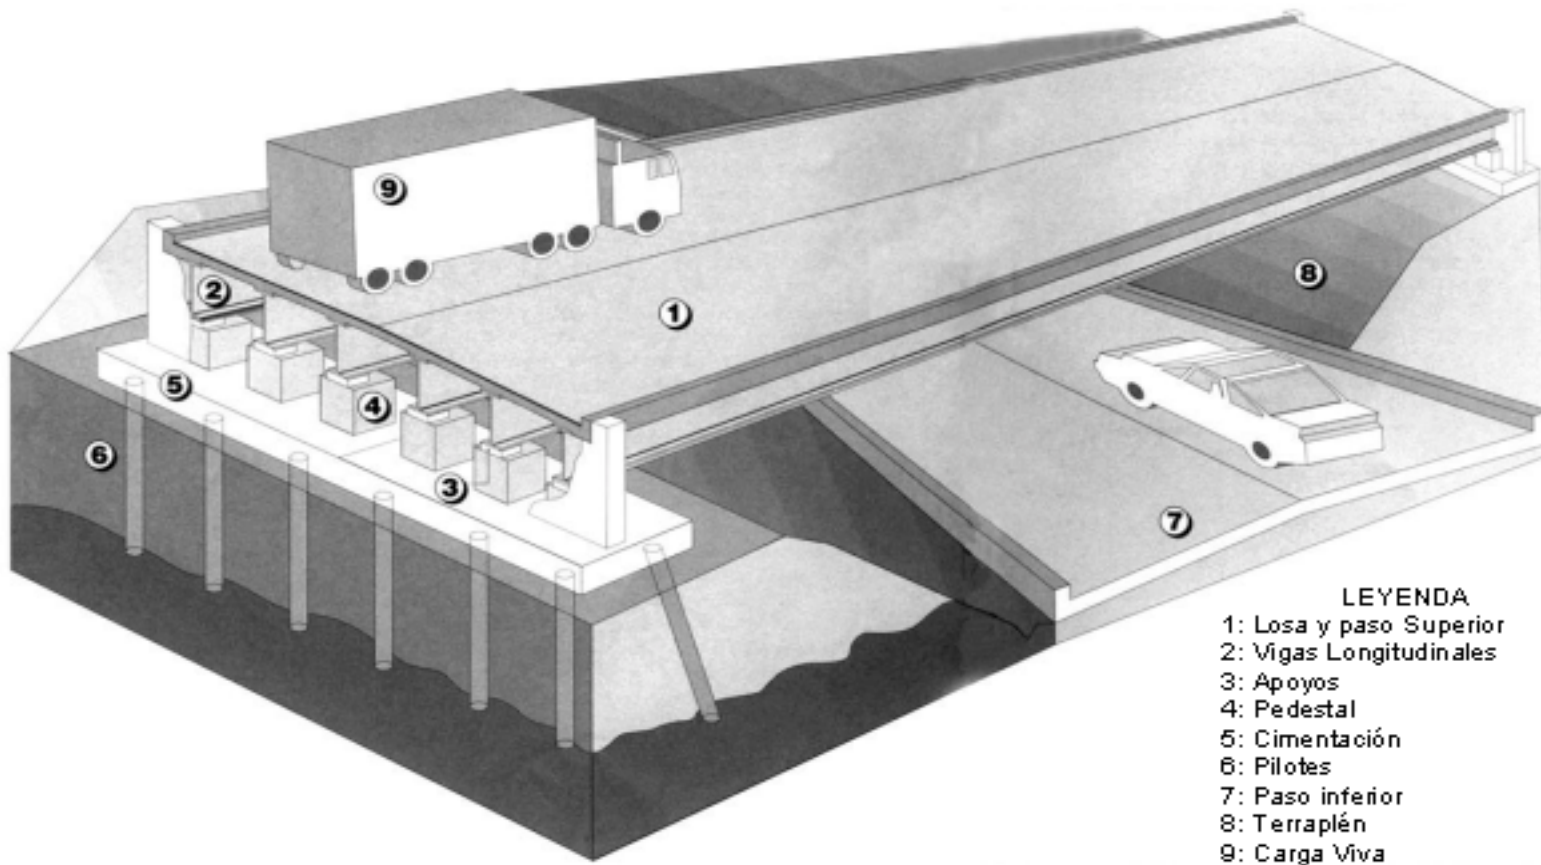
Puente típico MIXTO o losa sobre vigas (slab-on-stringer) en el sitio, y sus componentes representativos.
